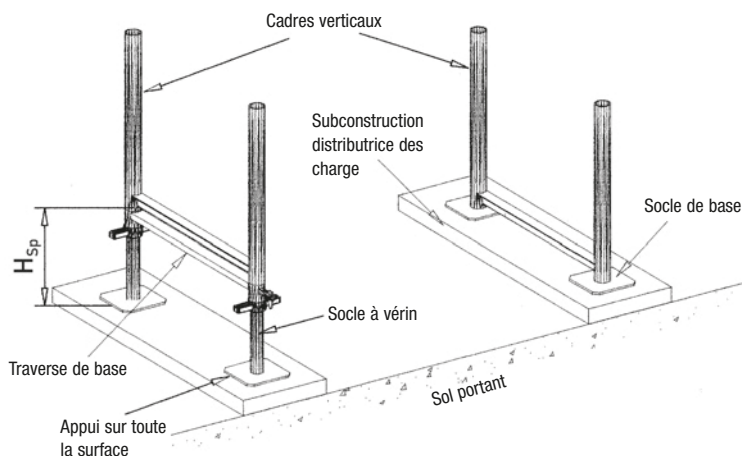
Subconstruction distributrice des charges avec plateaux d'échafaudage
